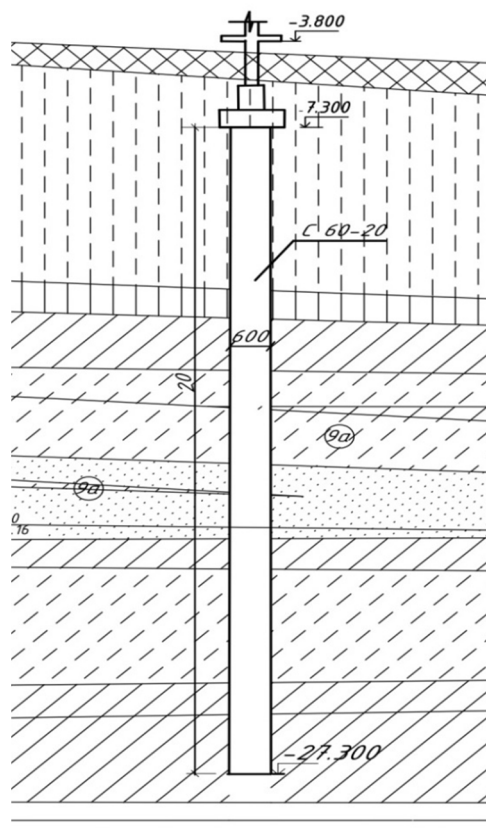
Розміщення в ґрунті пальового фундаменту
